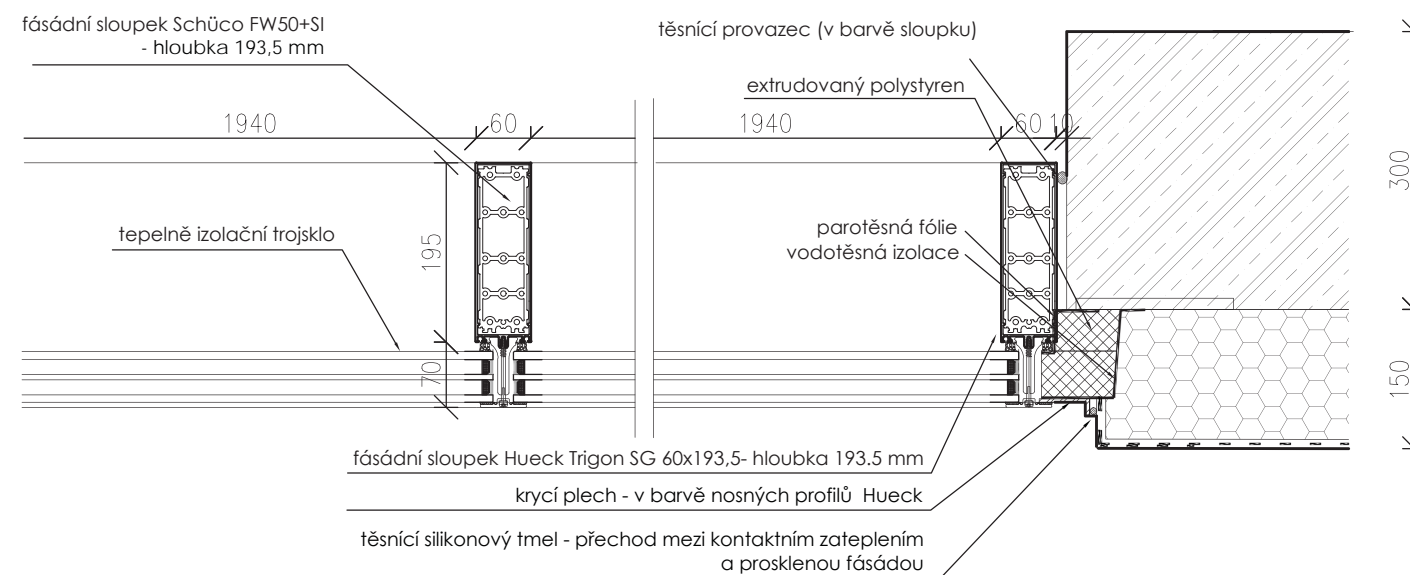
DETAIL NÁROŽÍ LOP - PŮDORYS M 1:5
